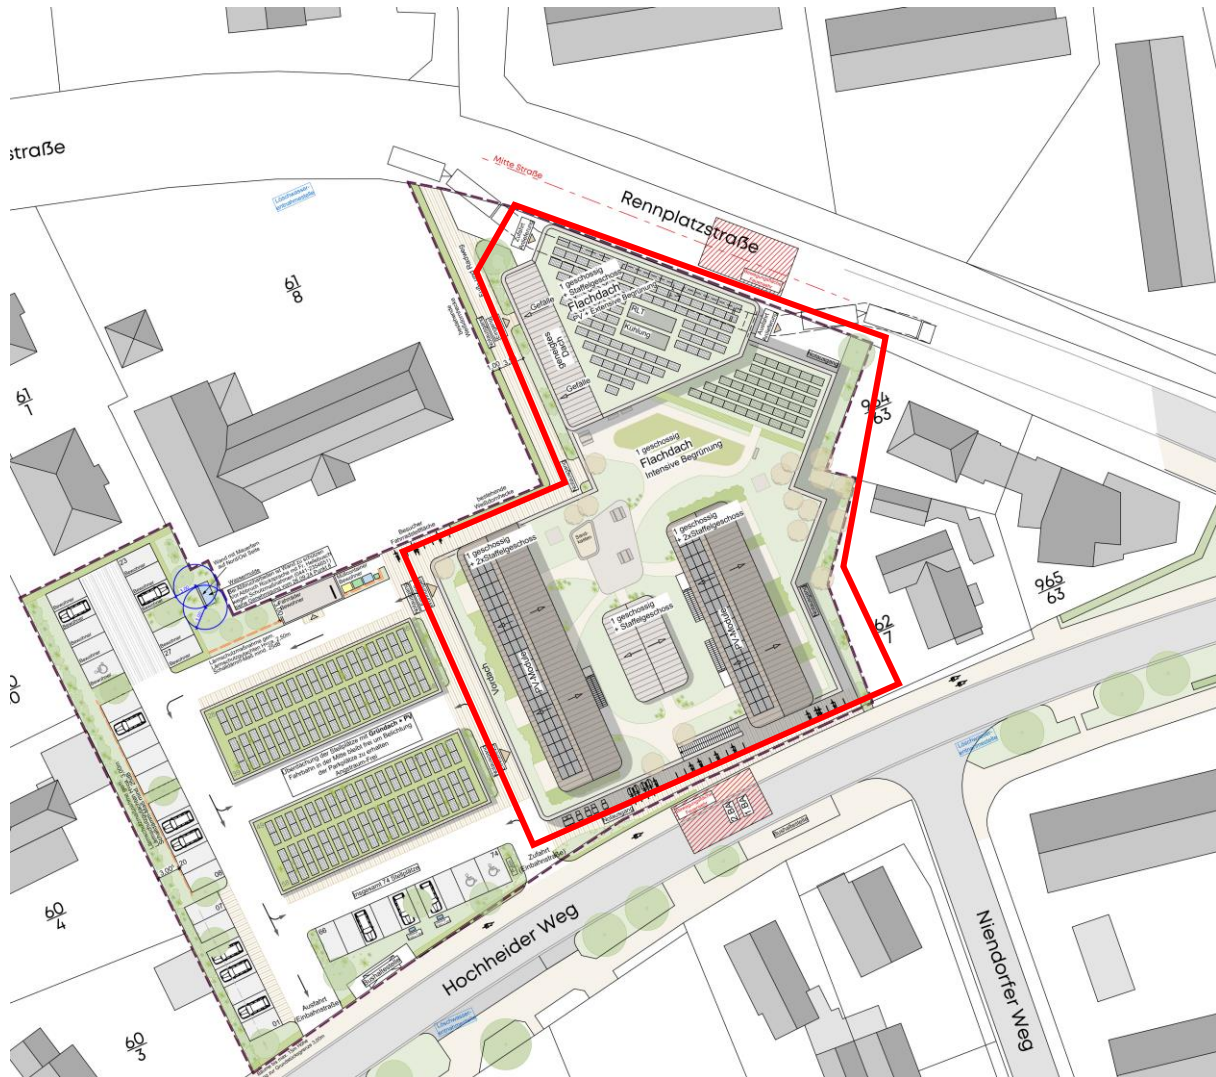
Beurteilungsumfang (Auszug Lageplan, erstellt durch 9grad Architekten BDA, vom
